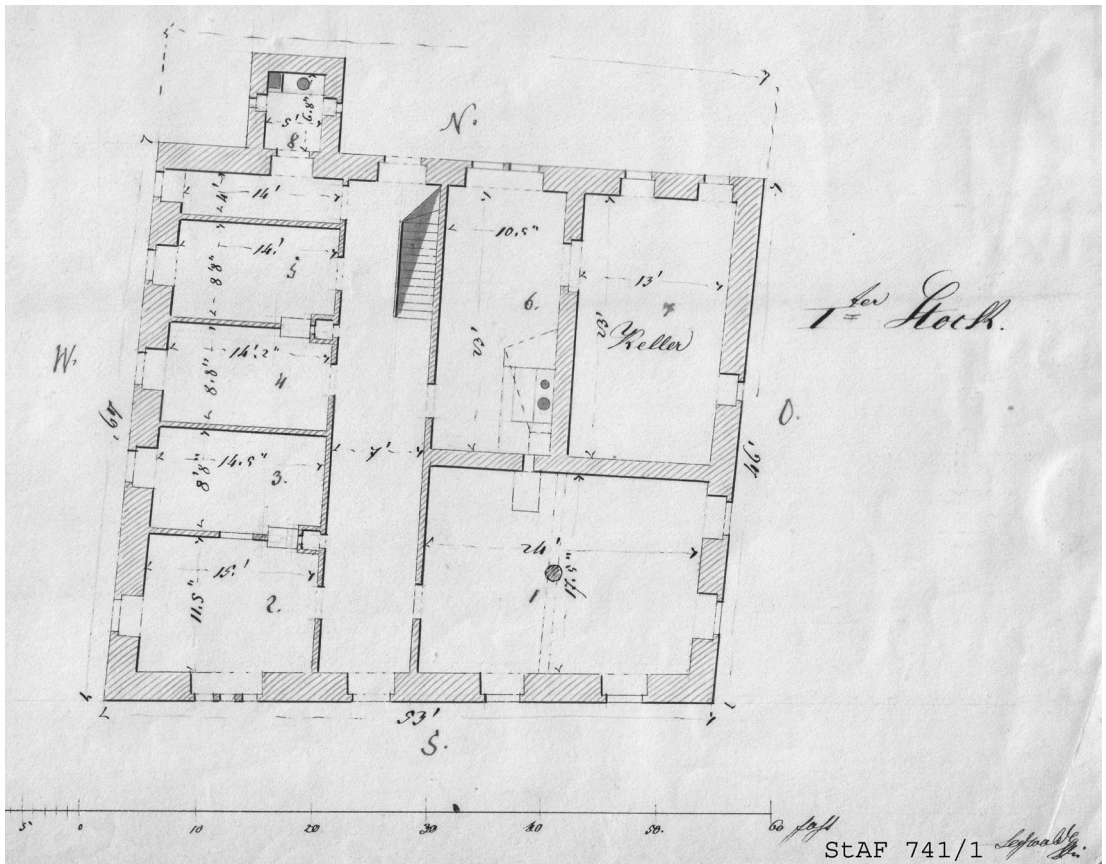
Spitalstraße 33, Grundriss Erdgeschoss im Jahr 1846.
